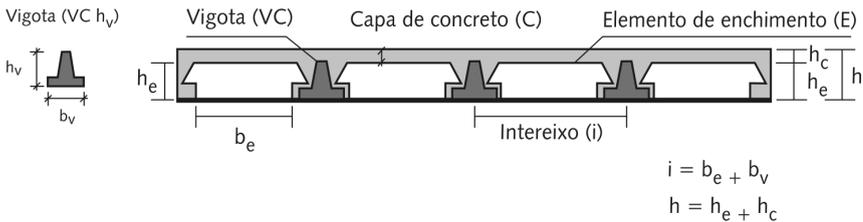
Lajes com vigotas de concreto armado (LCh)
